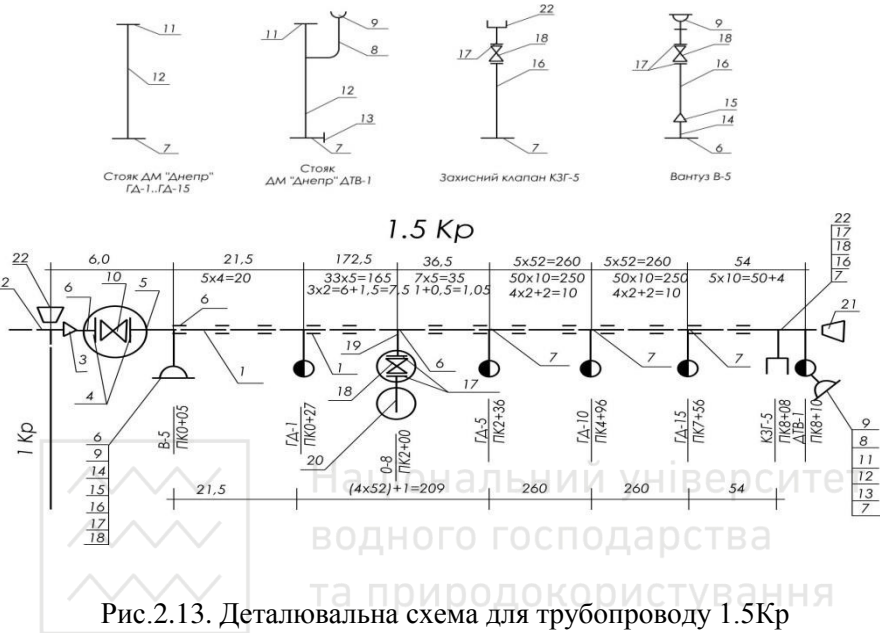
Деталювальна схема для трубопроводу 1.5Кр
